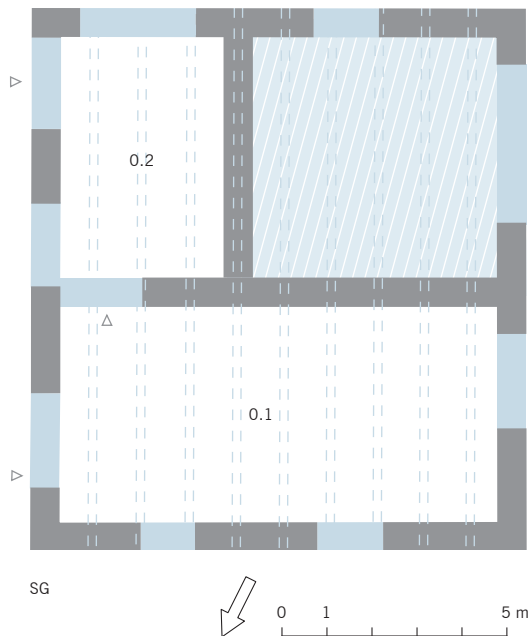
Hauptstrasse 1 in Oberägeri, Grundriss des Sockelgeschosses.
